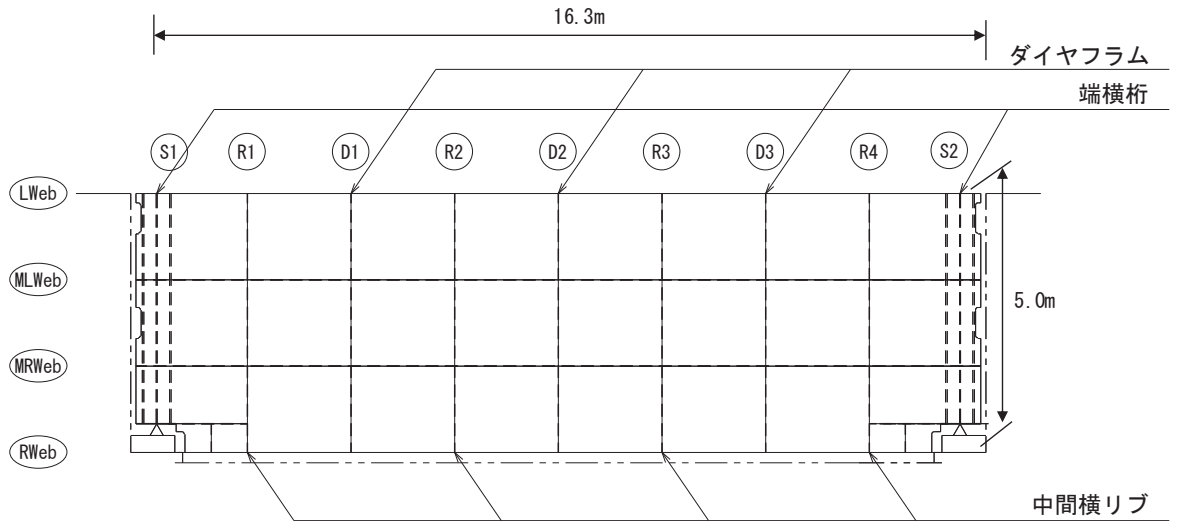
(2) 鋼製遮水壁（鋼桁 5） 平面図
